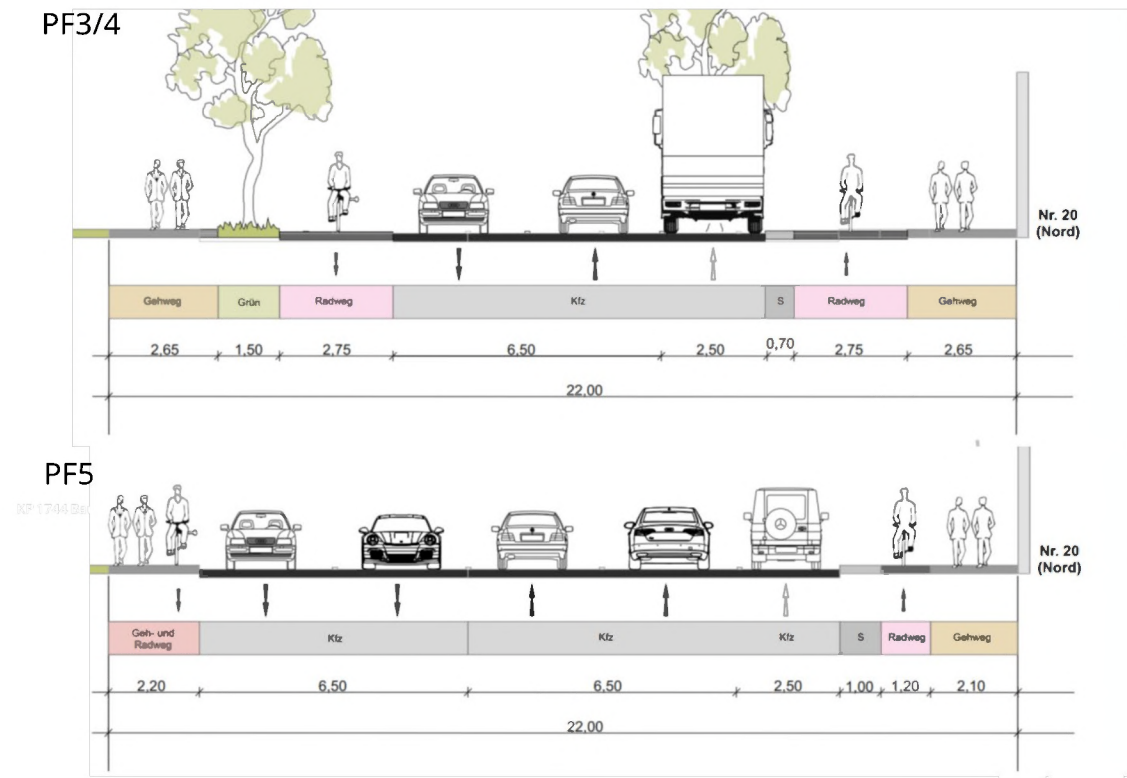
Konzept Planfall 4+4FS (Planfall 5) im Vergleich zu Planfall 4 – Querschnitt 3
